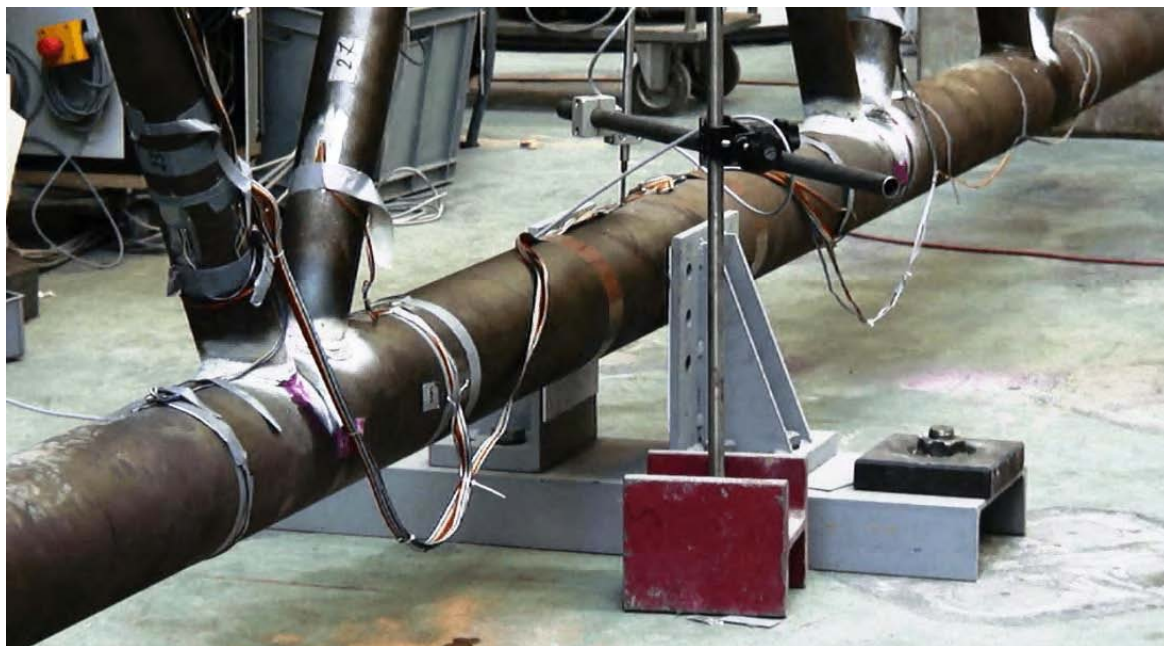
Detalhe da braçadeira para restrição de movimentações [63]
